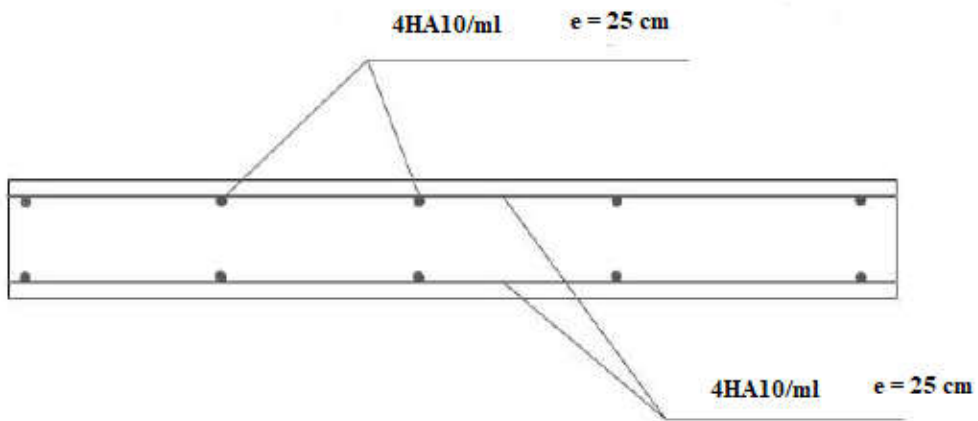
PLAN DE FERRAILAGE DE LA DALLE TRIANGULAIRE.
